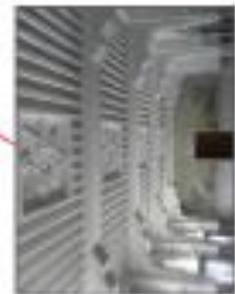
Plancher dalle des rampages. Source : Aoutar 2015.
